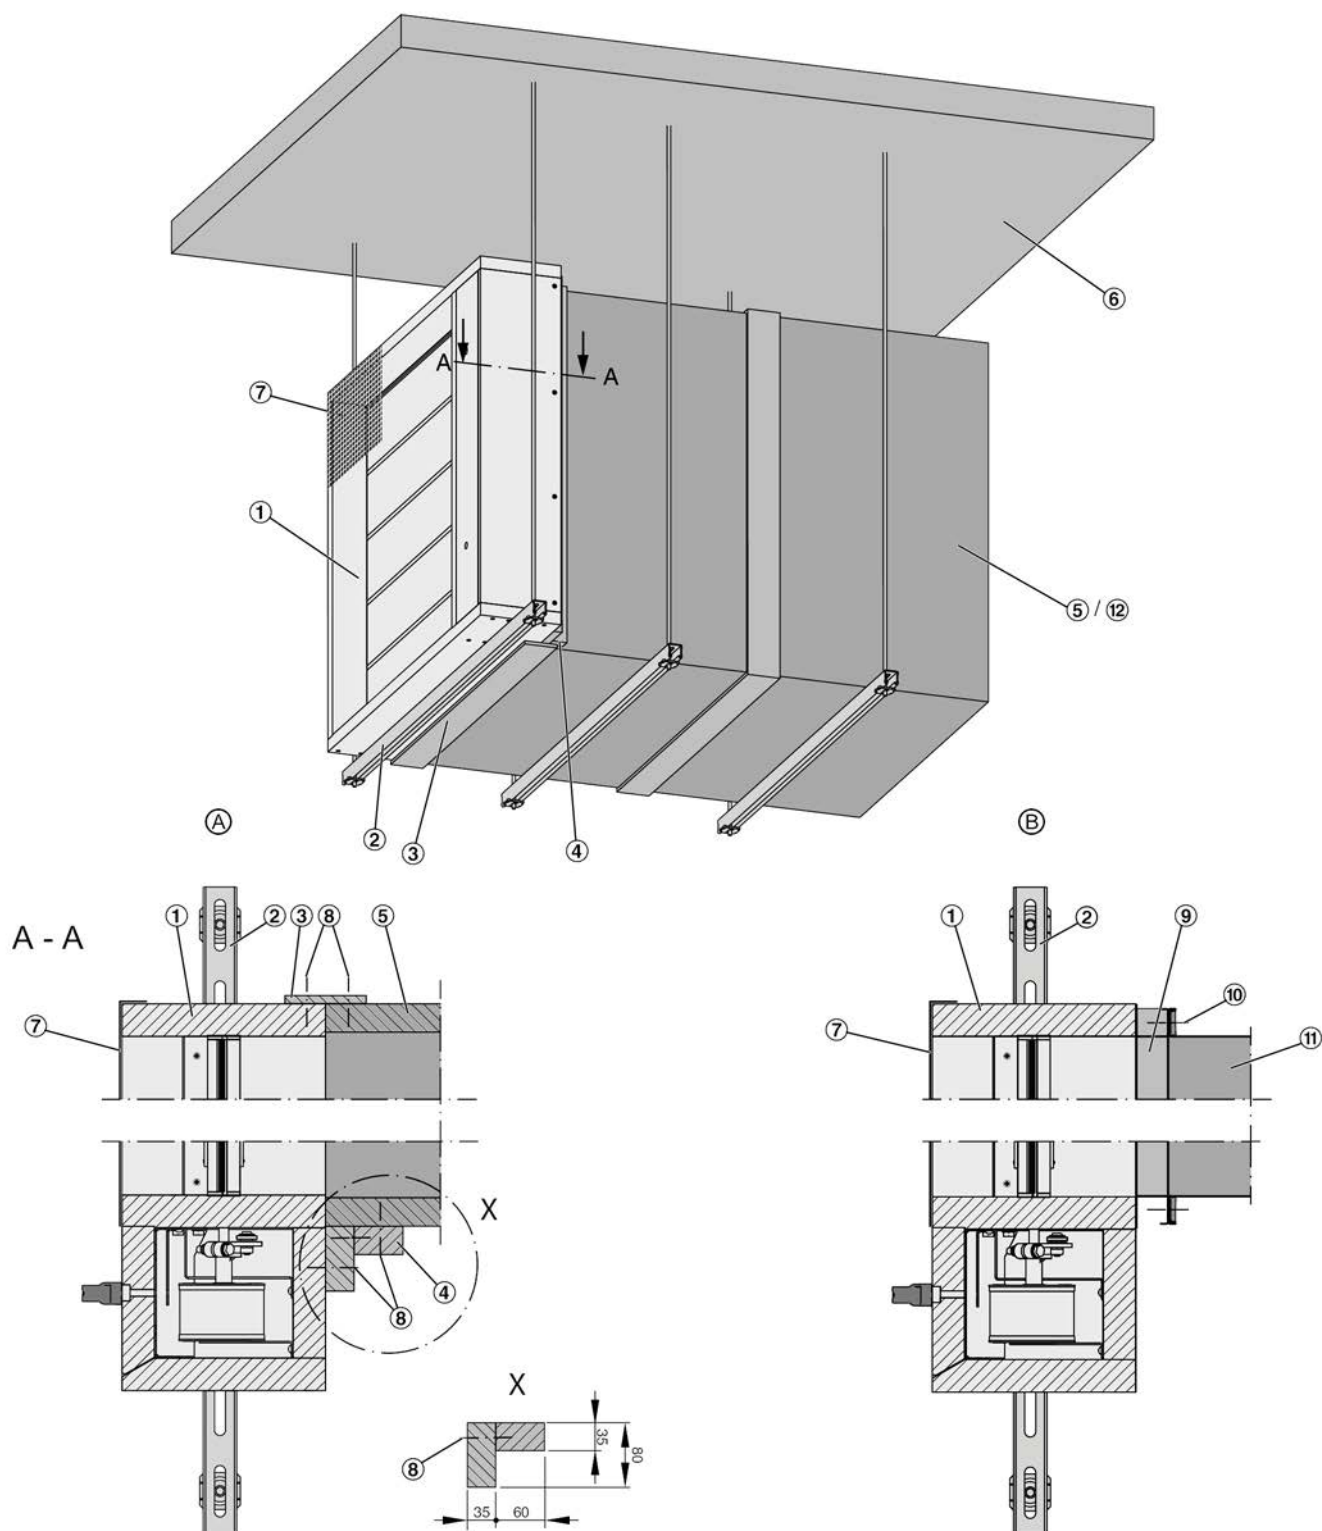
Installazione all'estremità di un condotto di estrazione dei fumi orizzontale
